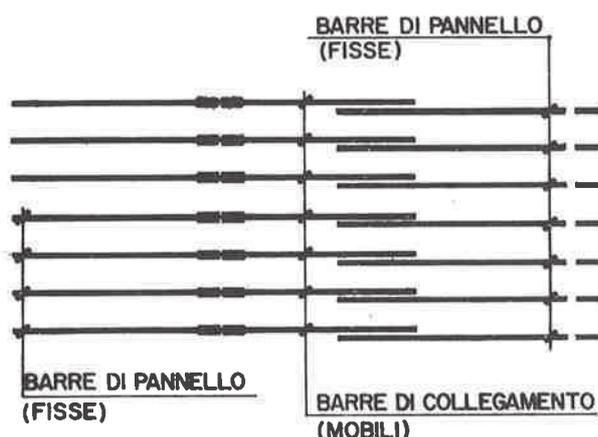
Collegamento tra gabbie contigue con giunto meccanico
